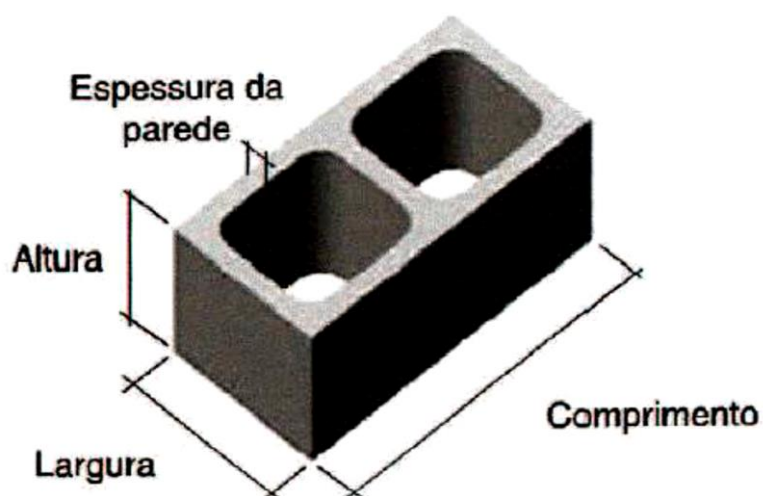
Bloco Vazado de Concreto Simples (ABNT NBR 6136, 2016)
